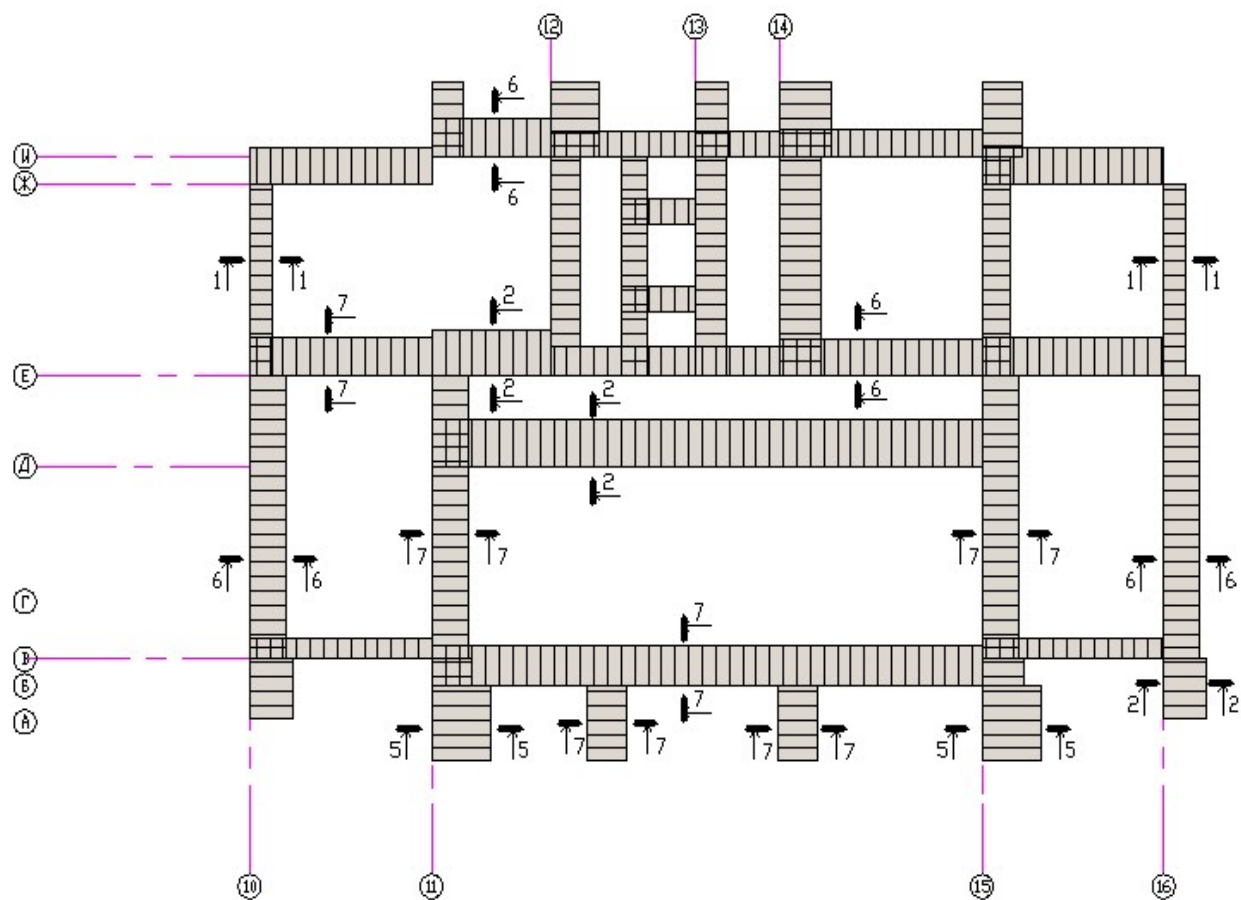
Схема навантажень на фундаменти Секція №2
